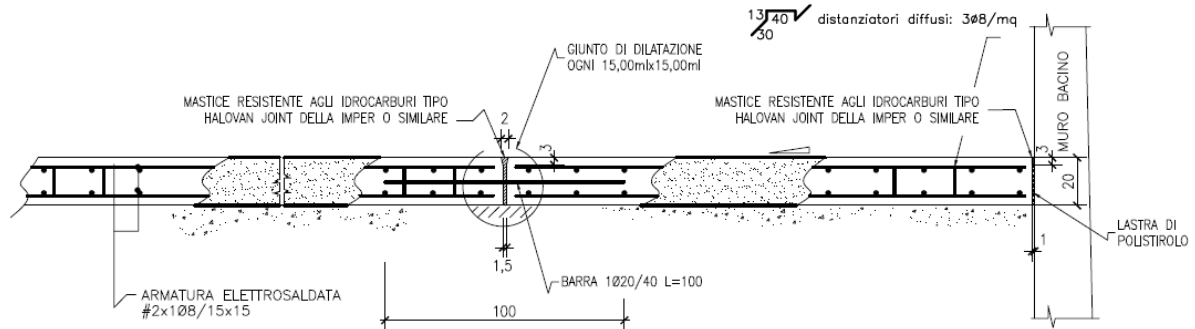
Pavimentazione bacini di contenimento – Schema costruttivo (Tip. 3)
